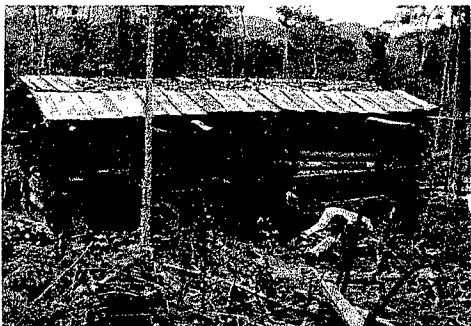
Casa en Canaán de muesca con techo de láminas de madera, plástico y paja.
